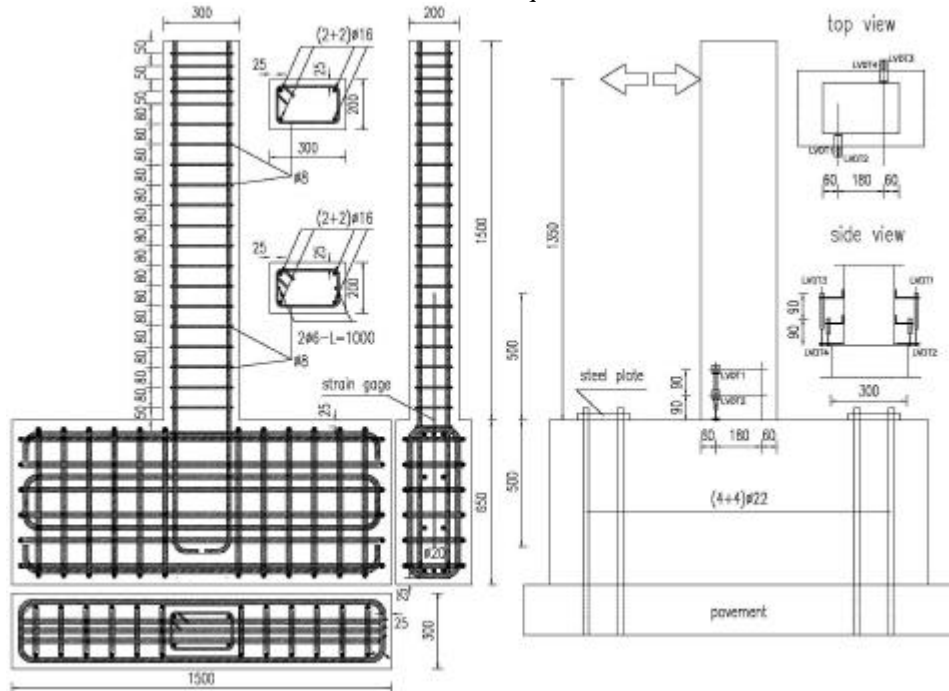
Geometria del prototipo colonna, armatura e strumentazione
